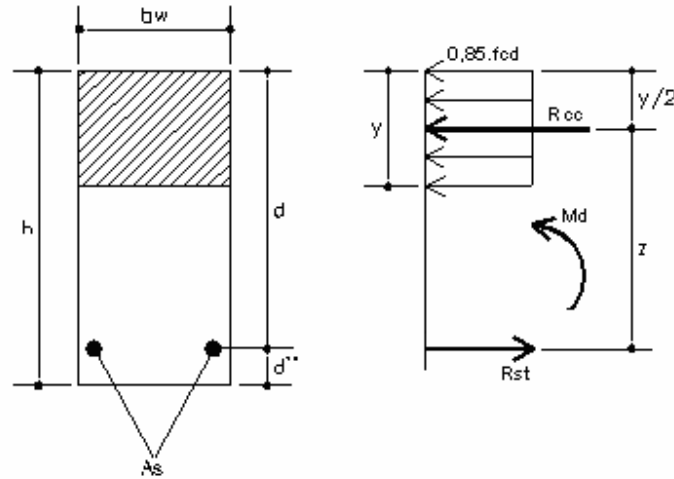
Seção transversal de uma viga retangular sujeita à flexão simples com armadura simples
